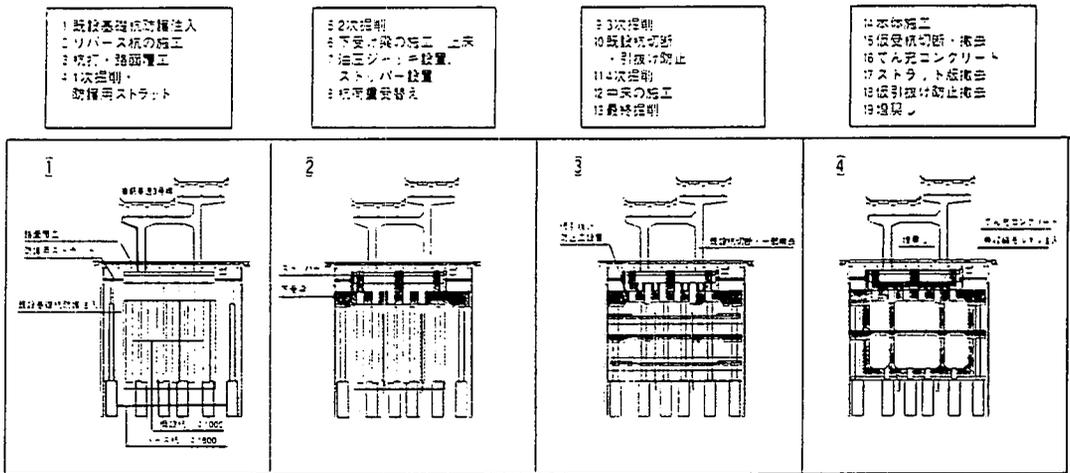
首都高橋脚下受（アンダーピニング工法）施工順序図
